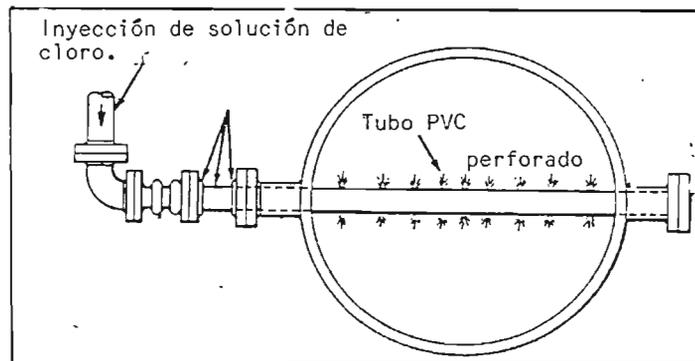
Difusor Instalado en tubería vista frontal (1)
